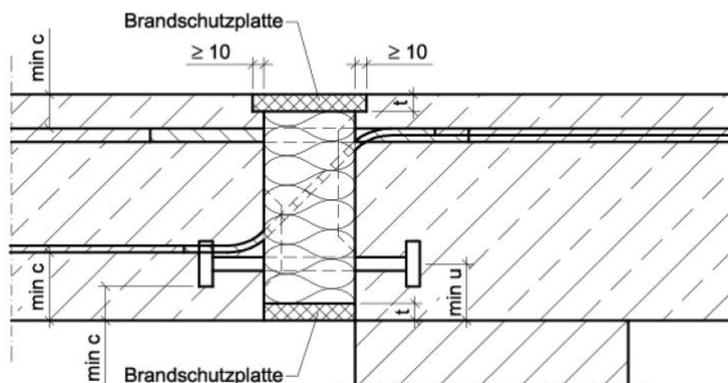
Schöck Isokorb® Typ K und Typ K-F mit SCE
